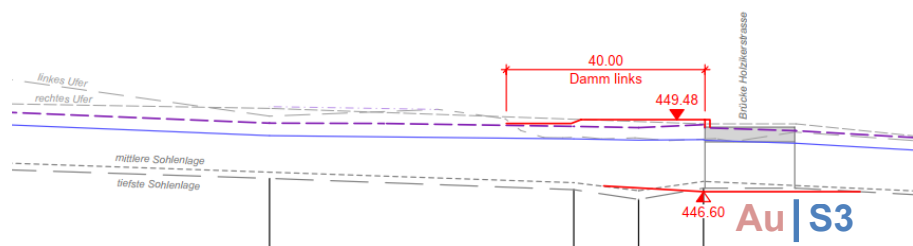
Längsschnitt Bereich Brücke Holzikerstrasse mit Lage geplante Sohlenabsenkung (in rot) im Vergleich zur aktuellen Gerinnesohle (grau), Kissling + Zbinden AG, Planstand 01.07.2025
